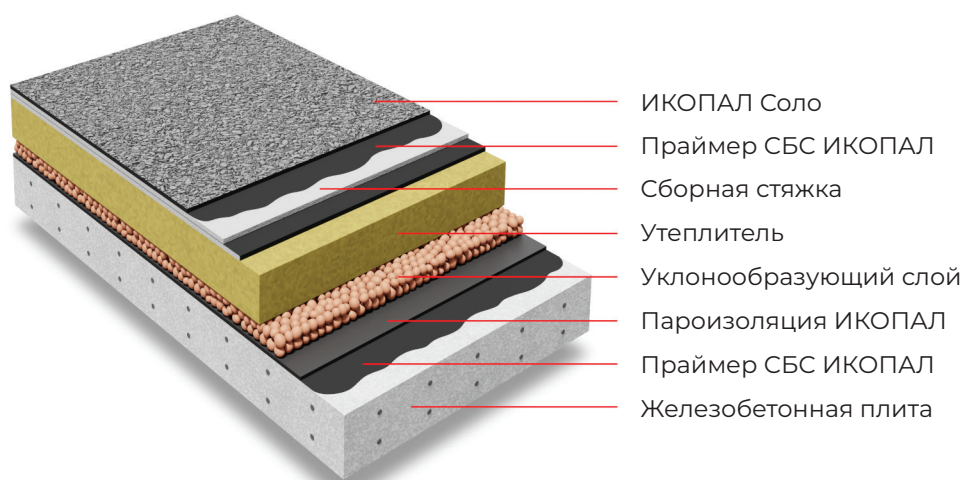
Вариант неэксплуатируемой кровли с однослойным кровельным ковром
